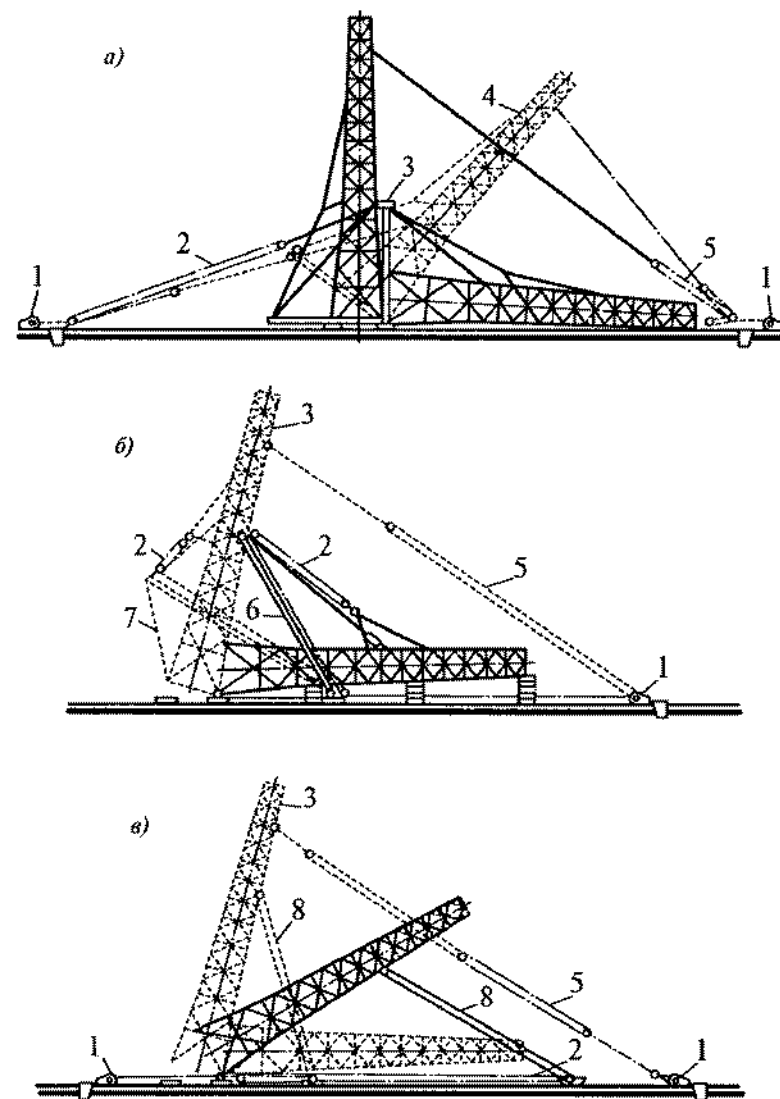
Монтаж башни поворотом вокруг шарнира:
